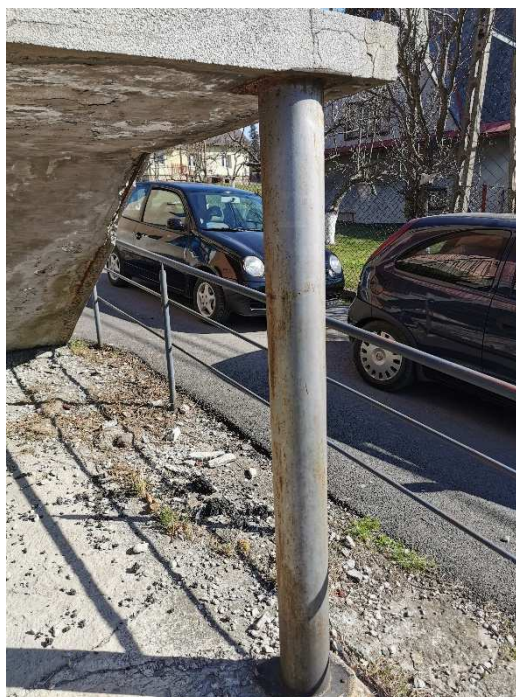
Widoczne odspojenia zewnętrznej warstwy tynku. Widoczne oznaki zniszczenia betonu. Balustrada w dobrym stanie technicznym
